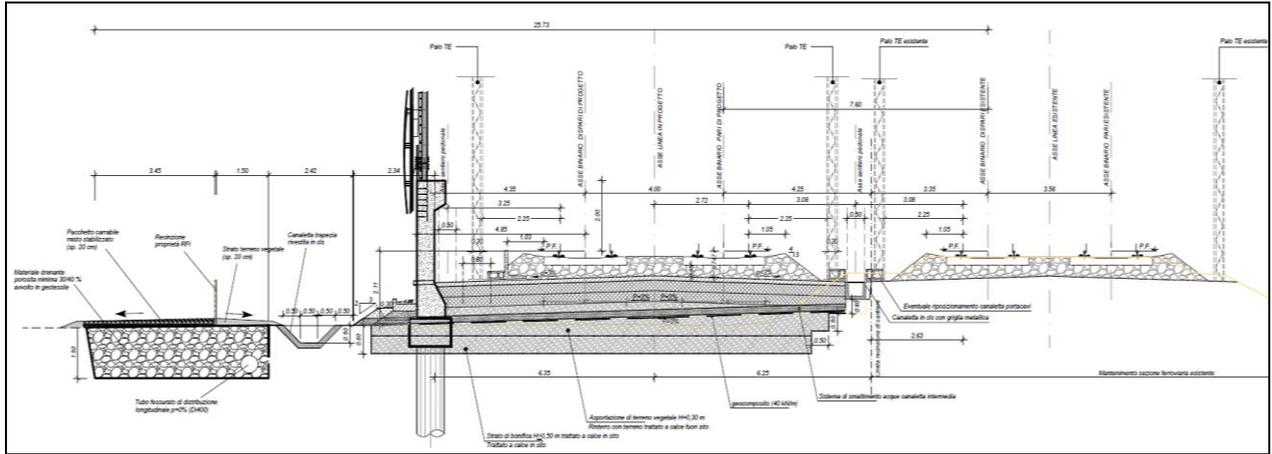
Sezione tipo della piattaforma ferroviaria con BA Standard RFI posizionata su muro antisvio, lato BD di progetto
